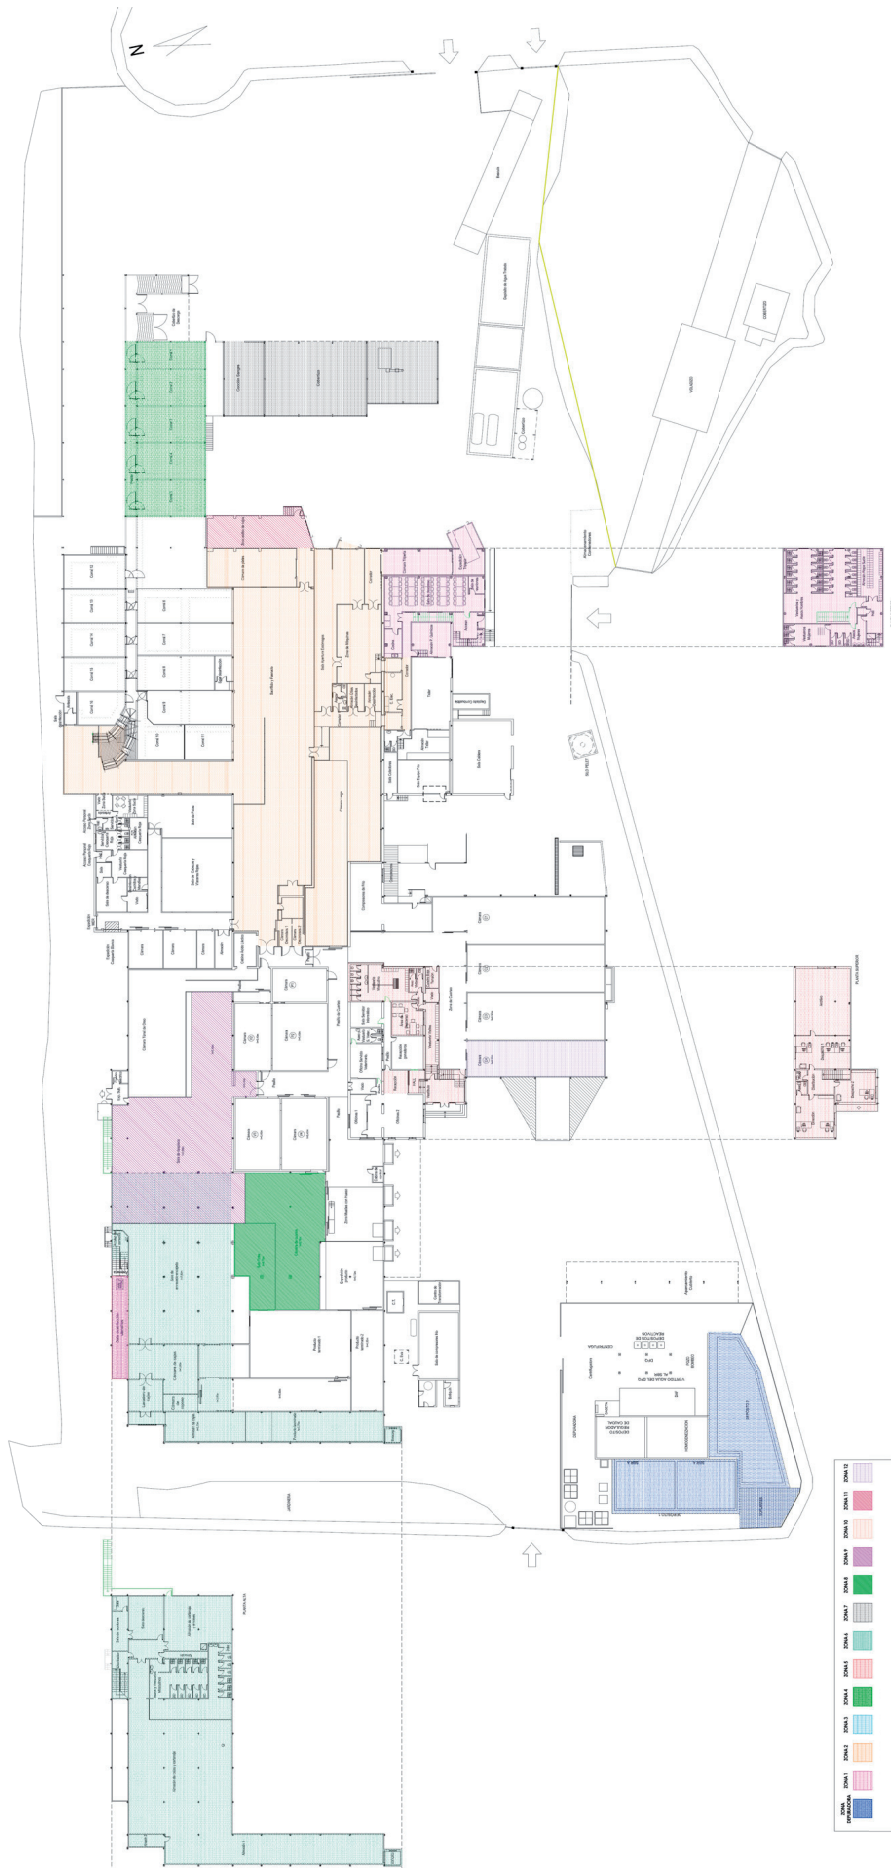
Plano en planta de la instalación, en el que se resaltan las zonas en las que se llevarían a cabo modificaciones
